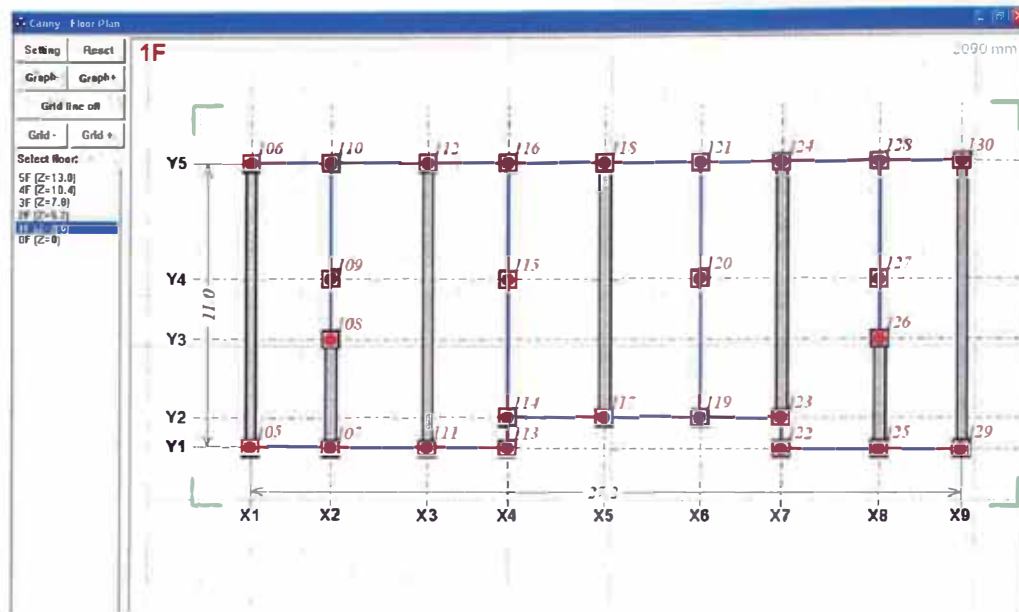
Vista de Planta en Modelo Canny – Piso Típico
